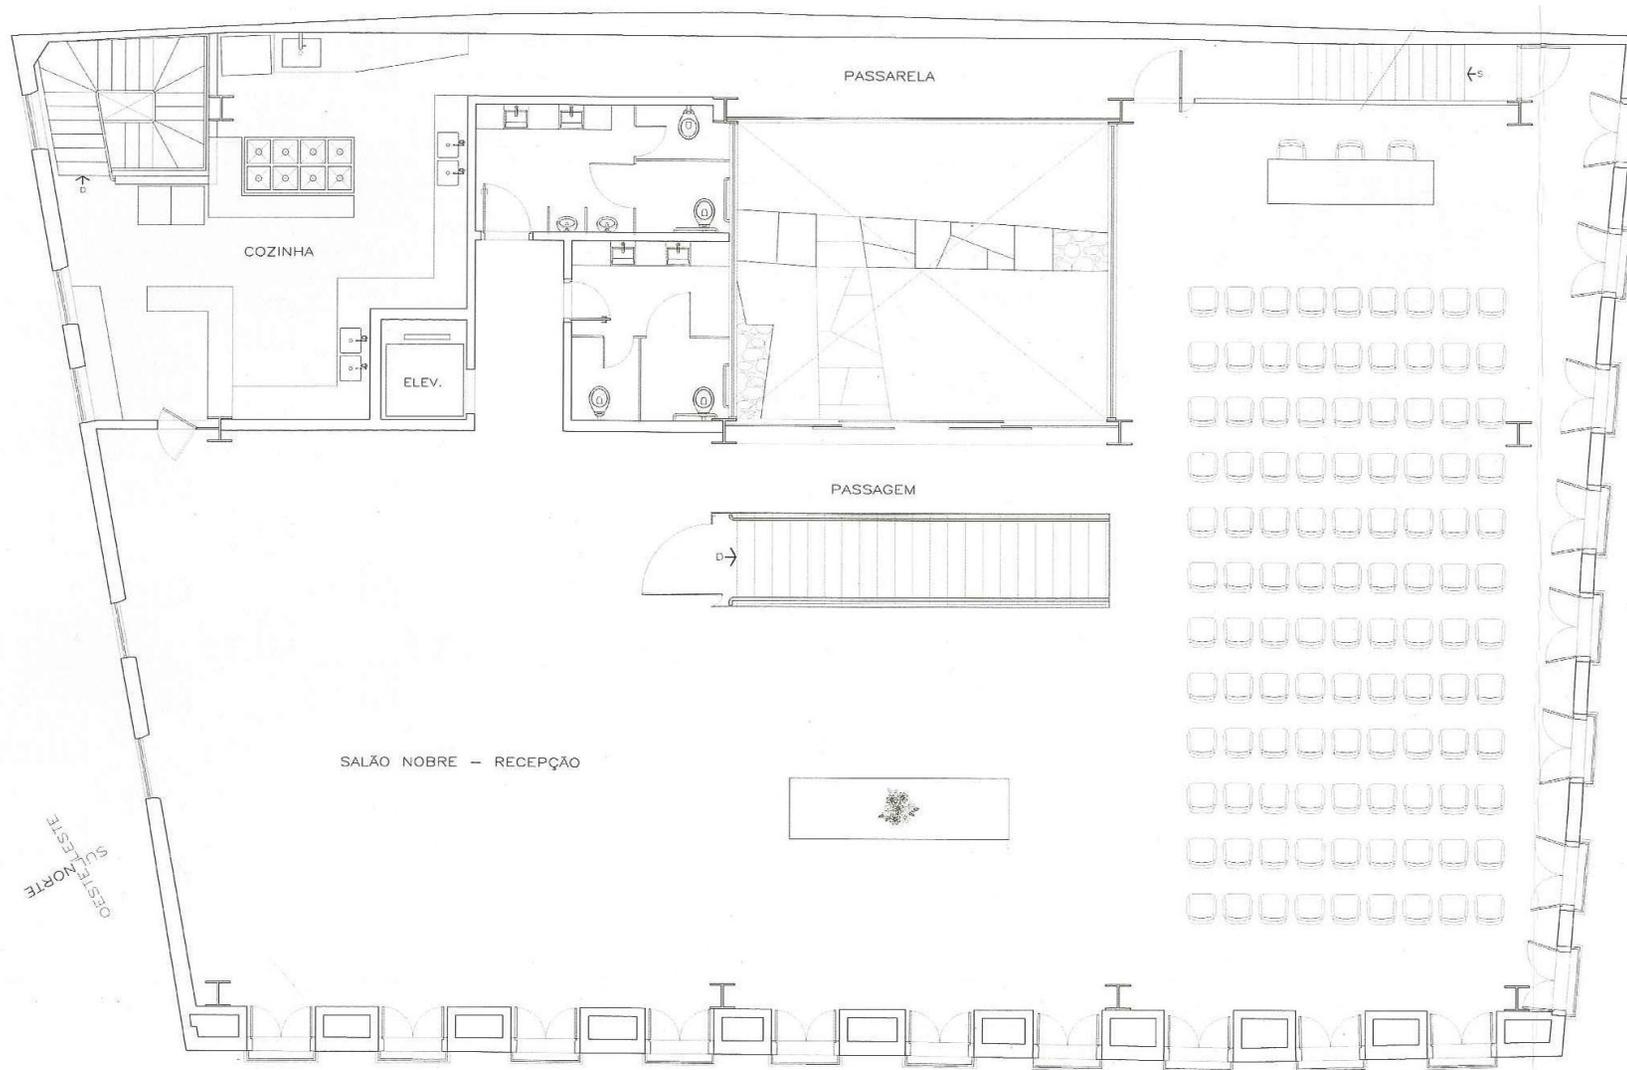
Planta 2º pavimento. Fonte: SESI/FIEMG, 2014.
